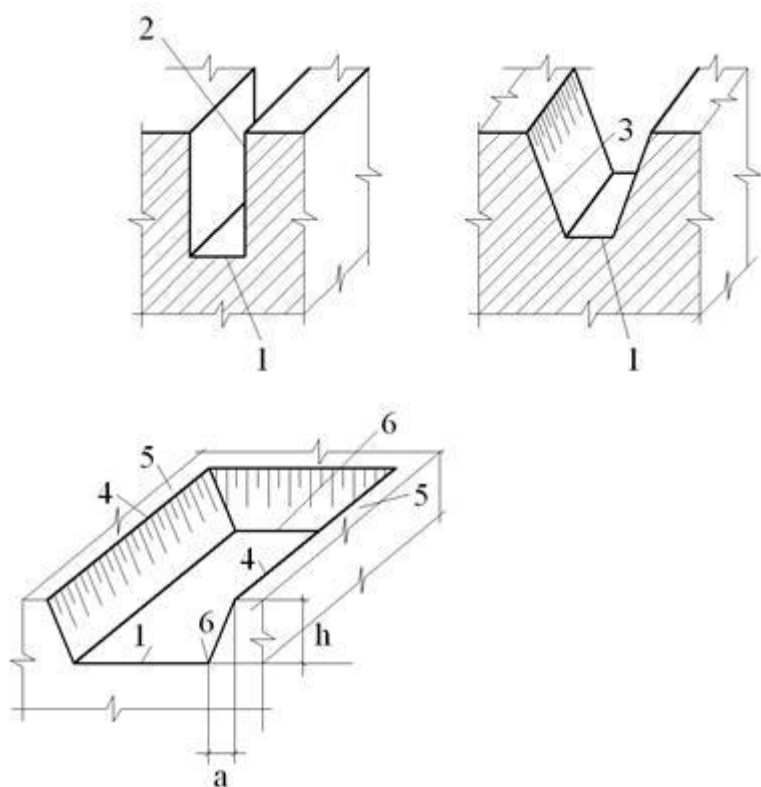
Виды земляных сооружений: а, б – траншеи с вертикальными стенками и с откосами; в – котлован под сооружение; 1 – дно (траншеи, котлована), 2 – боковая стенка траншеи; 3 – боковой откос (траншеи, котлована); 4 – бровка; 5 – берма; 6 – подошва.
